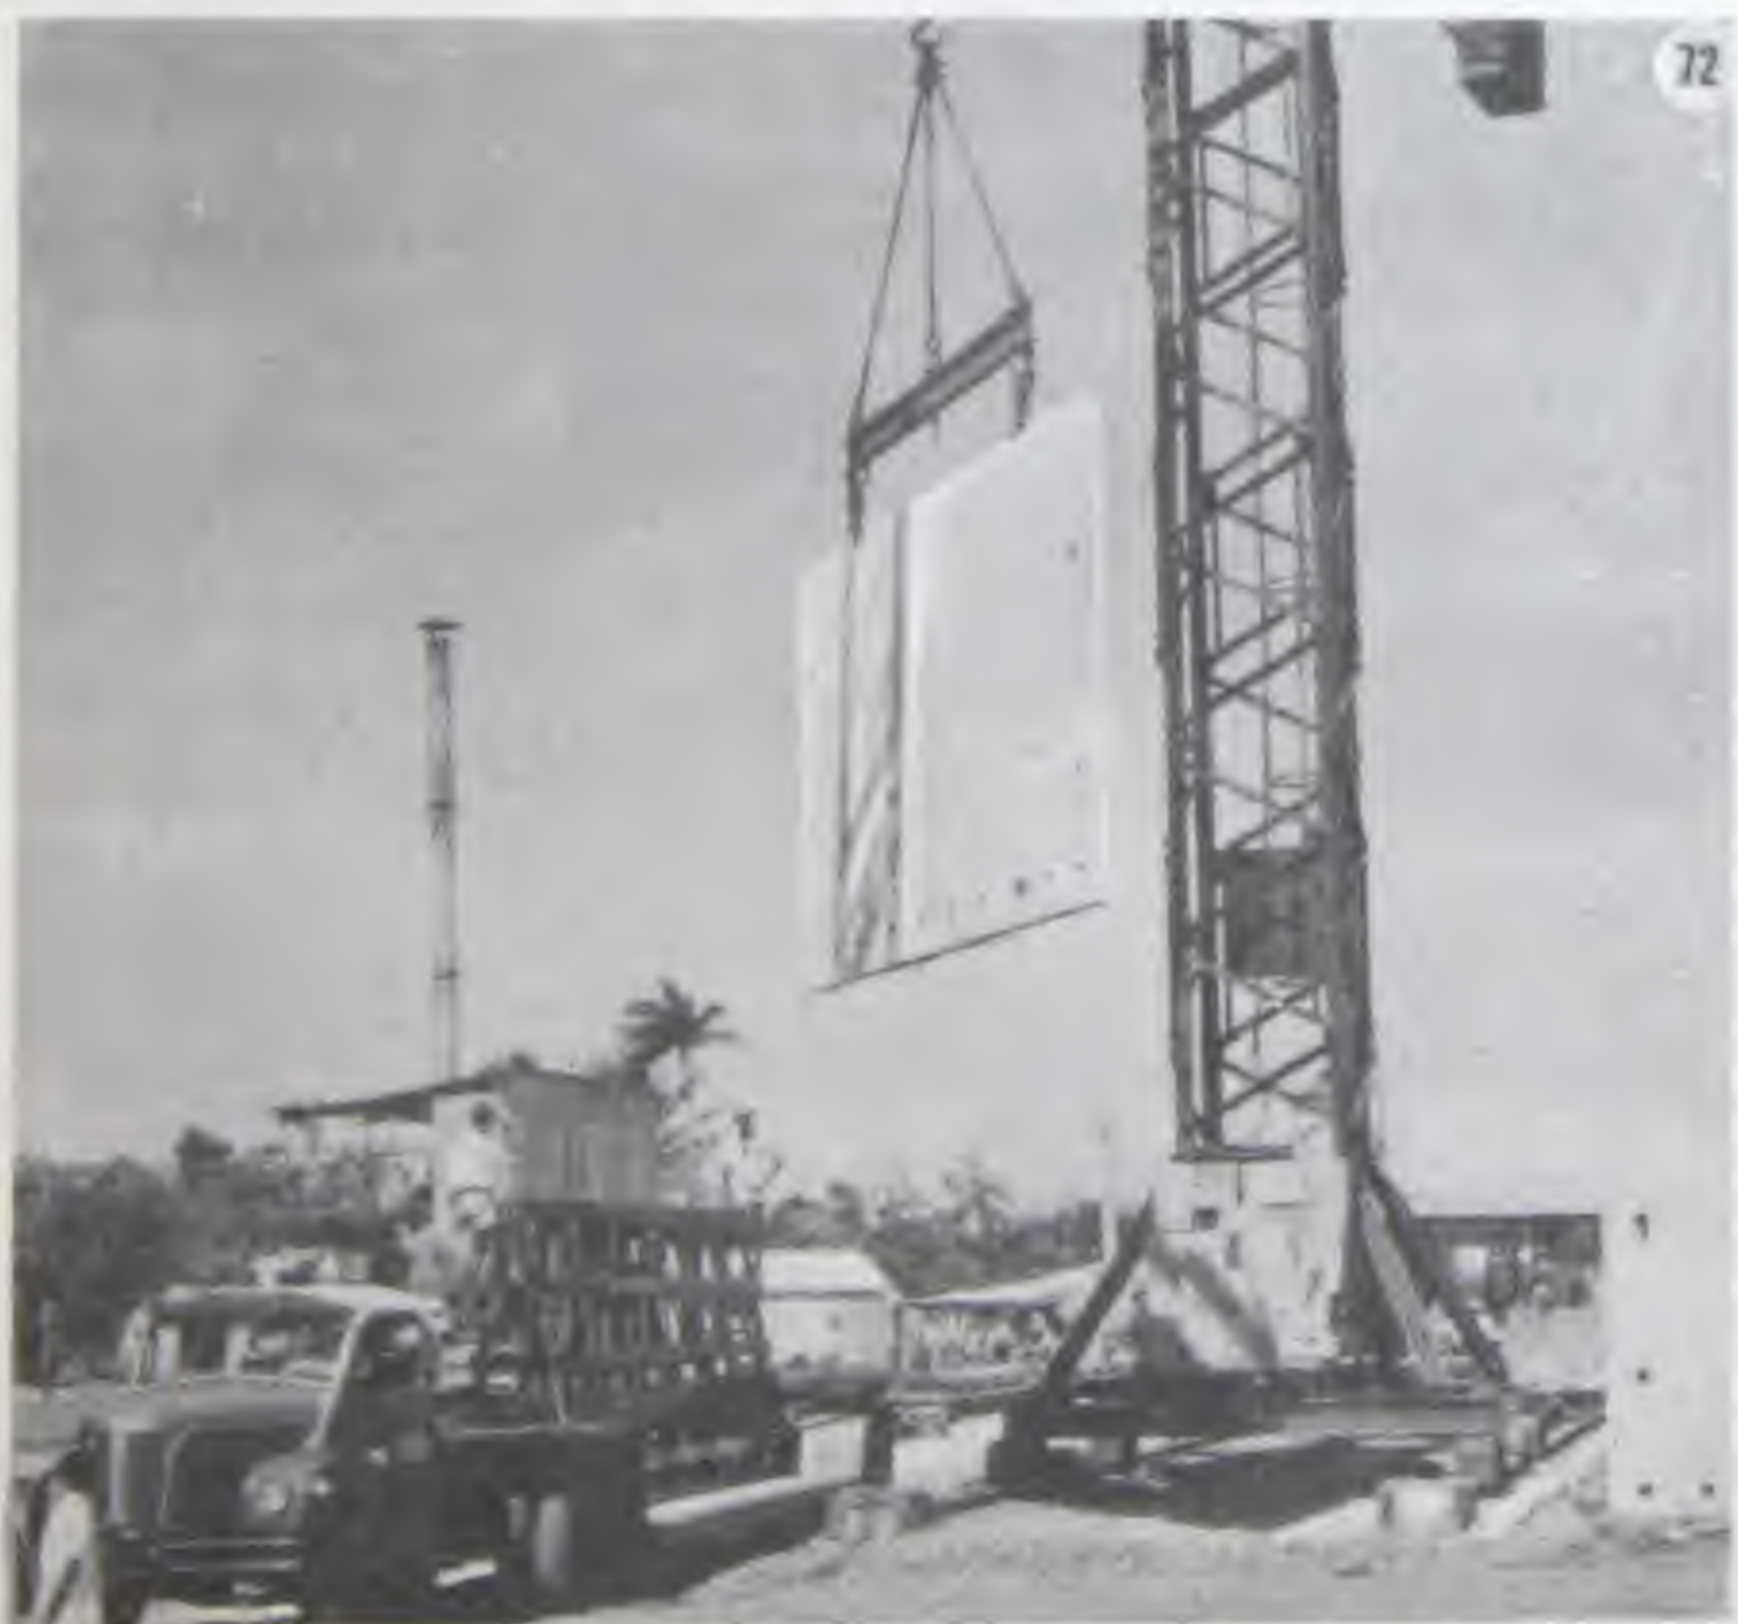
A 74.-REPORTAGE SUR LES CONSTRUCTIONS
